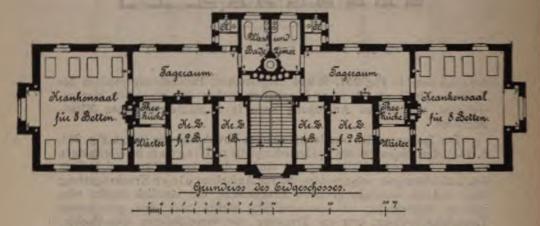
, Zweigeschossiger Isolierpavillon des Krankenhauses im Friedrichshain in Berlin.
